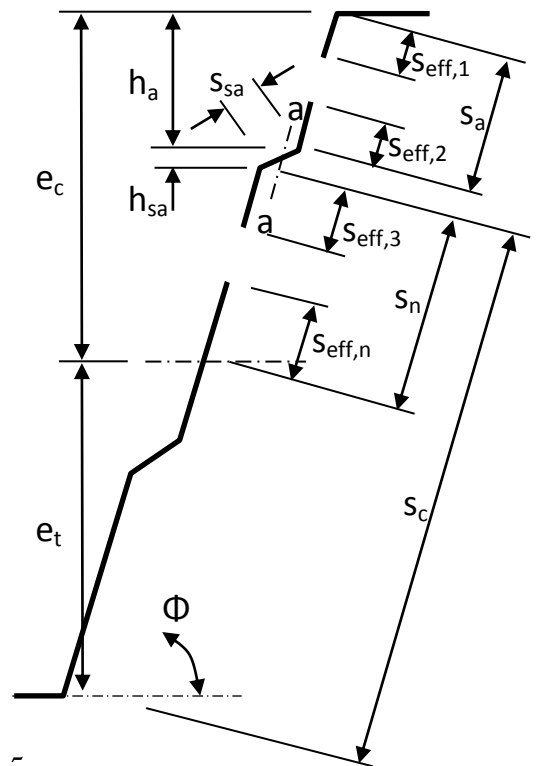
Sezione trasversale efficace delle anime di una lamiera trapezoidale
